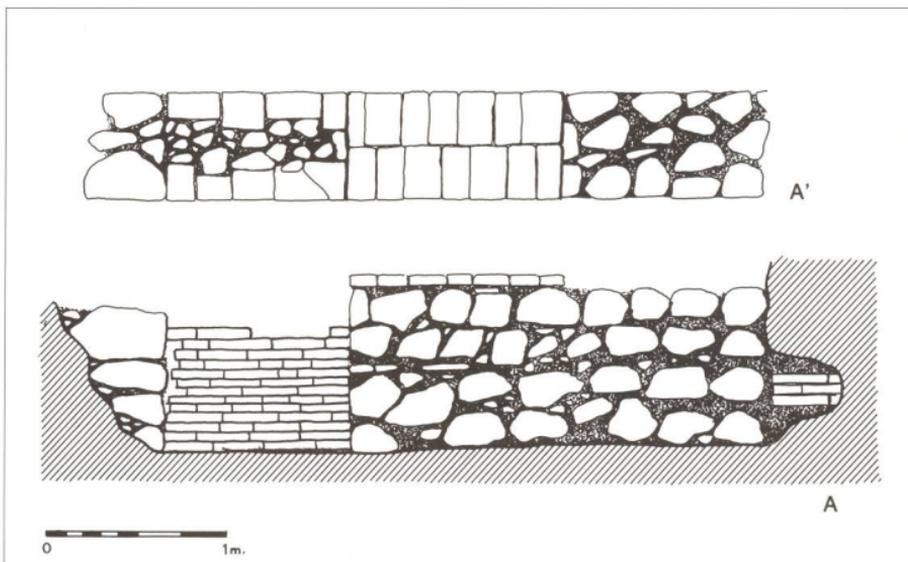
Singilia Barba. Muro realizado en piedras y argamasa, con pilares e hilada de nivelación en ladrillo.
